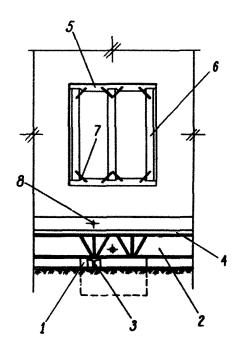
Схема усиления оконного проема (1 этажа), расположенного над домкратной нишей:
